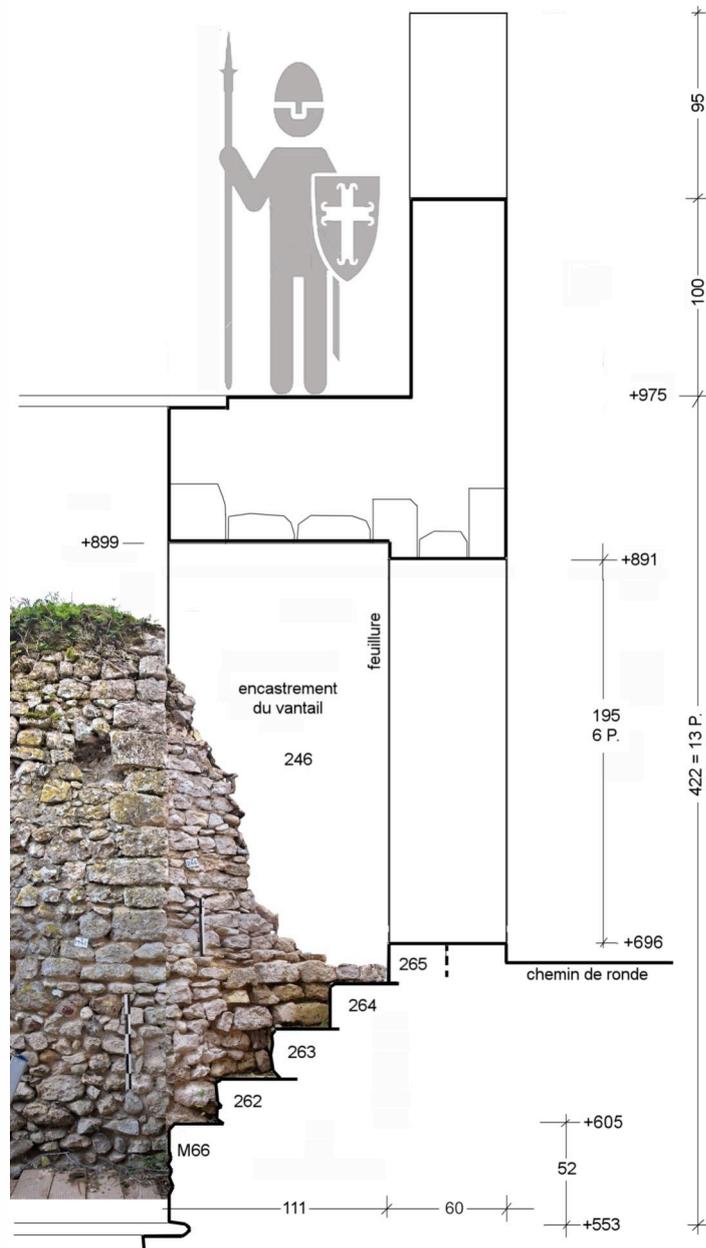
Élévation et coupe de la porte T5-21 et son escalier. Proposition de restitution (DAO : Michel Piechaczyk / ADM)
